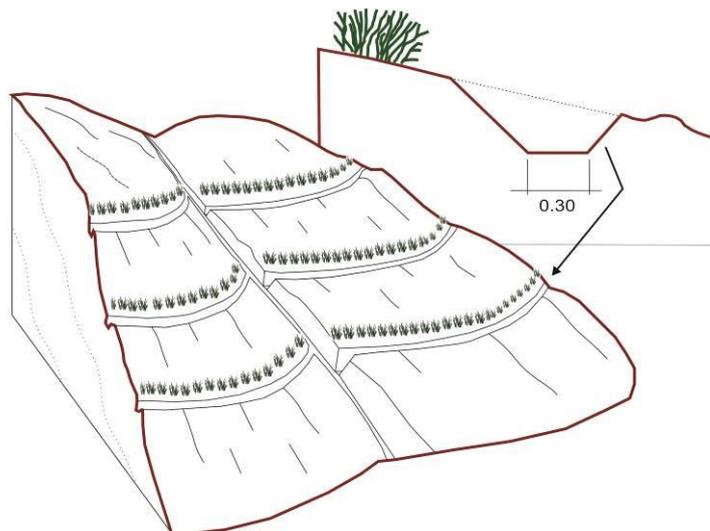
Sistema de drenaje en laderas ocupados por cultivos
